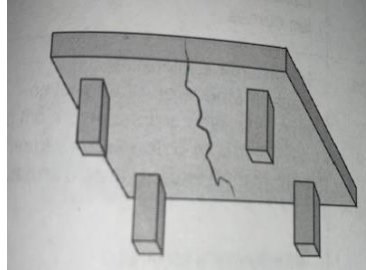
Fissuration centrale de la dalle [13].
